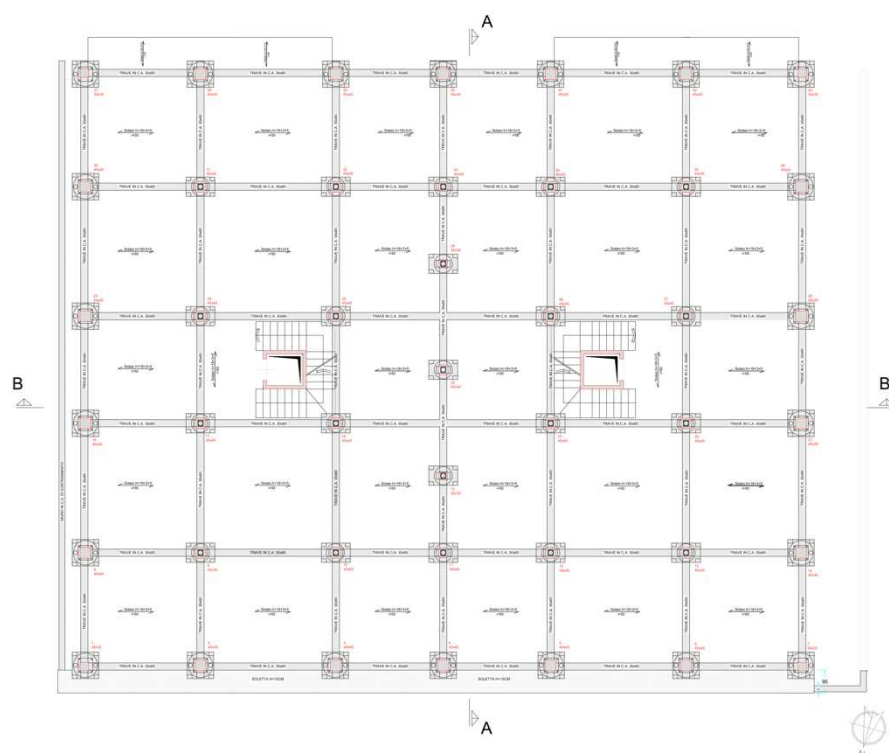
Carpenteria dell'edificio nello stato di progetto. Pianta piano terra (scala 1:50).
